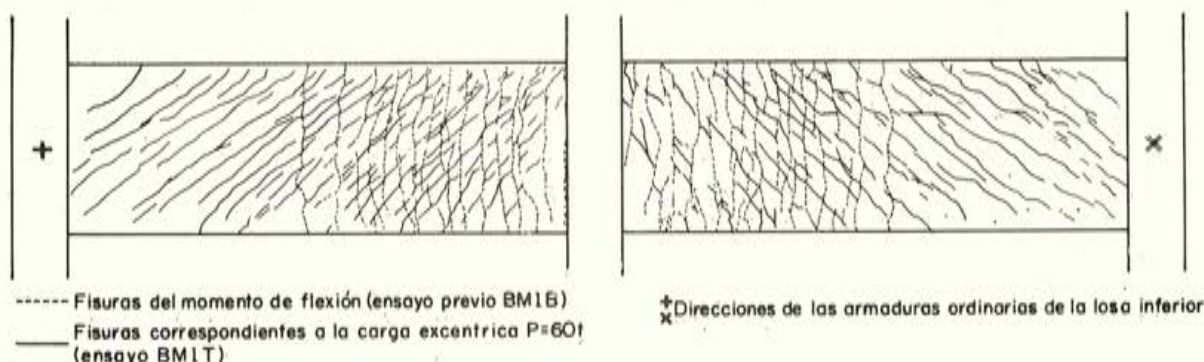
Esquema de la fisuración de la losa inferior de la viga BM1.
